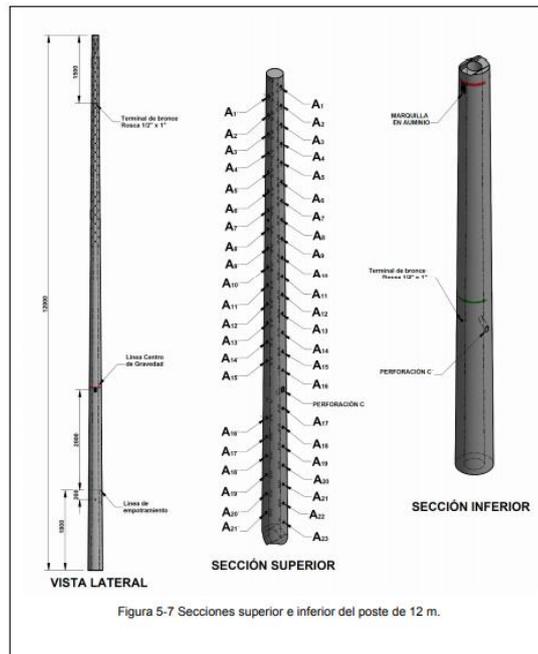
Poste de concreto de 12m Fuente.(Concreto, 2009)
